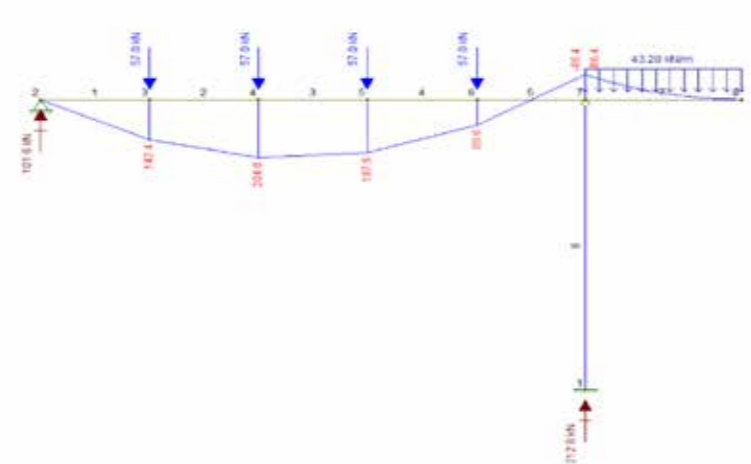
Schema statico trave appoggio appoggio estremo libero SLU
